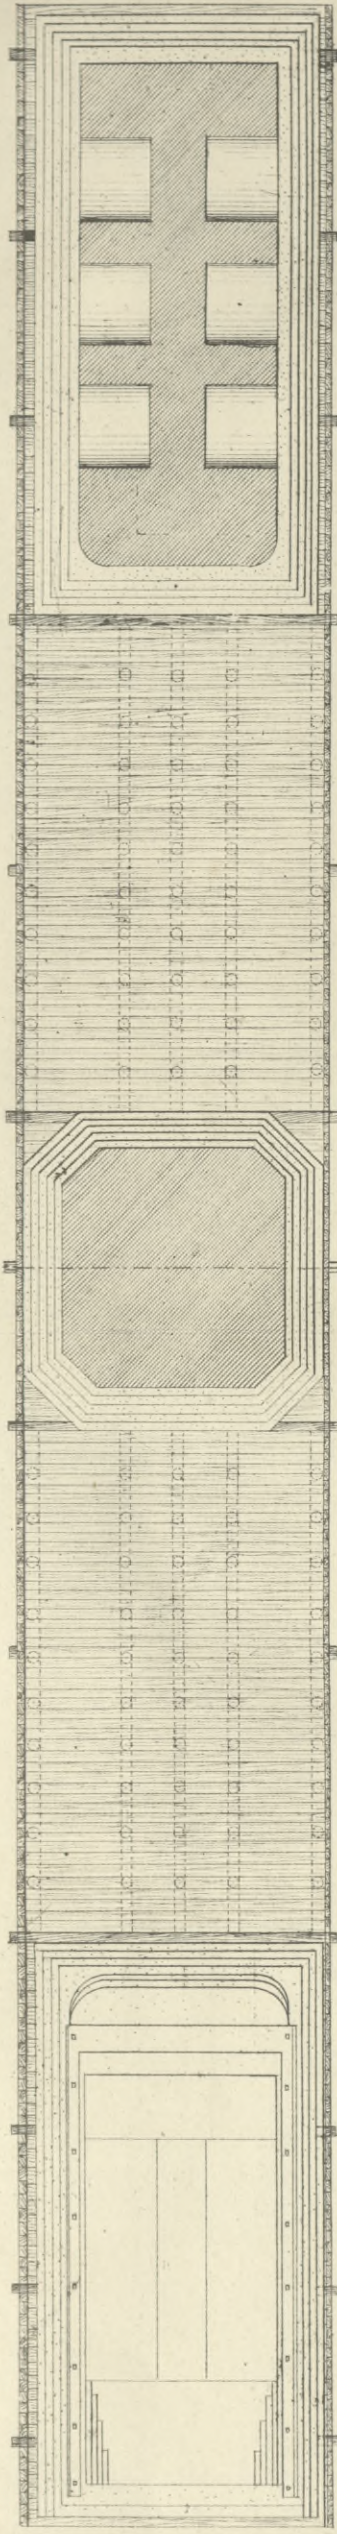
Plan du pilotage à 0^m005 p^r 1^m00
